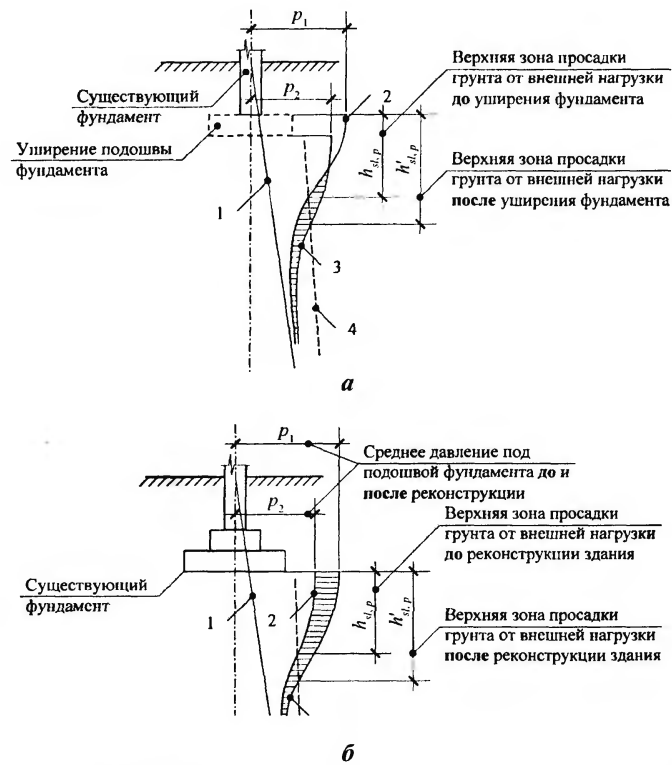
К усилению оснований, сложенных на просадочных грунтах, при увеличении площади передачи нагрузки на основание (а) или увеличении нагрузки на фундамент (б). 1 – распределение вертикальных напряжений от собственного веса грунта по глубине толщи; 2 – то же, от внешней нагрузки и собственного веса грунта до реконструкции; 3 – то же, после реконструкции; 4 – изменение по глубине толщи начального просадочного давления p_d
